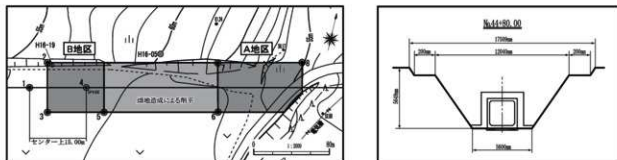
境界杭・グリッド設定基準杭位置図及び施工断面図
